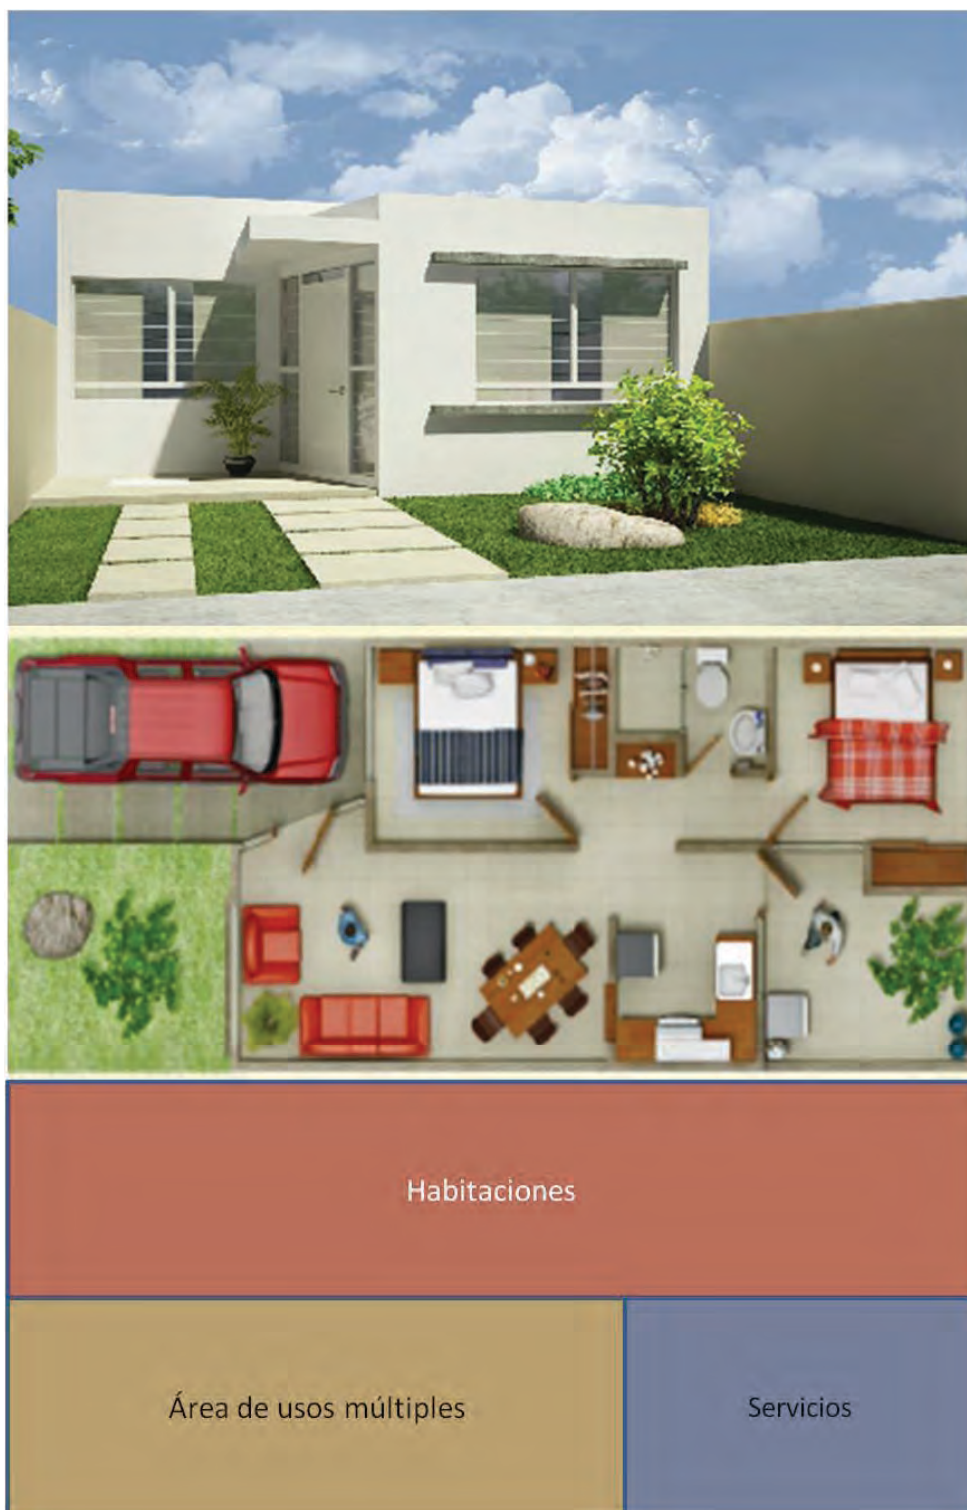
Fachada, planta perspectivada y esquema de funcionamiento de prototipo de estudio
